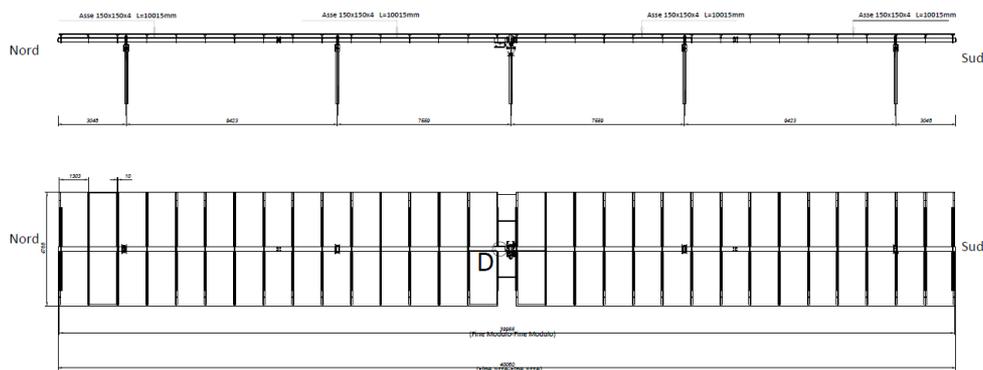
Particolare vista in sezione e in planimetria delle strutture
